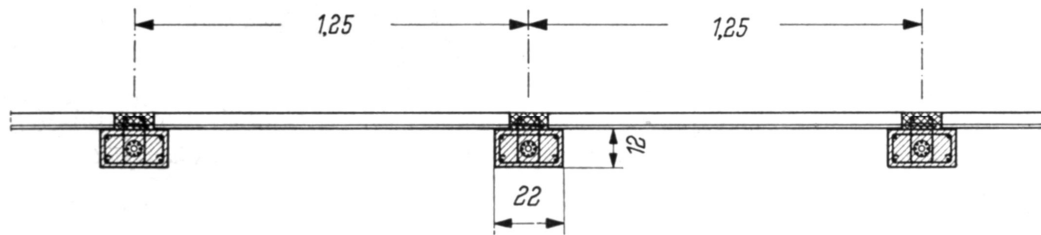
Querschnitt durch die Dachkonstruktion, Westfalahalle 4 Dortmund (BNr. 16) [Vaessen 1959]
